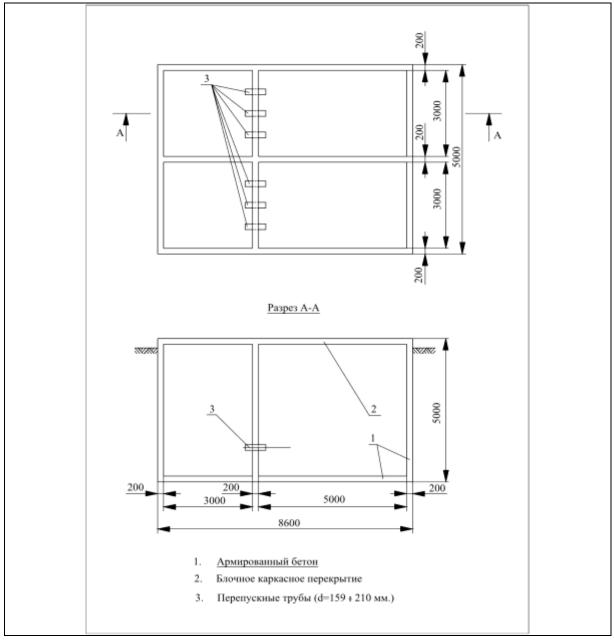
Конструкция корпуса приемного очистного резервуара.
